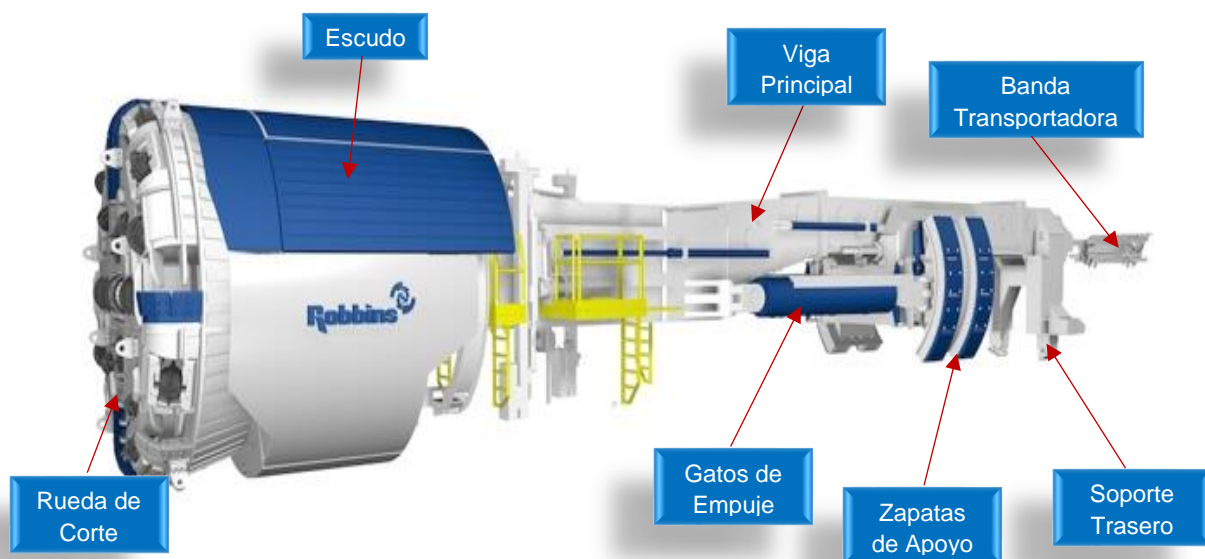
Componentes principales de un Gripper TBM (The Robbins Company, 2018).
